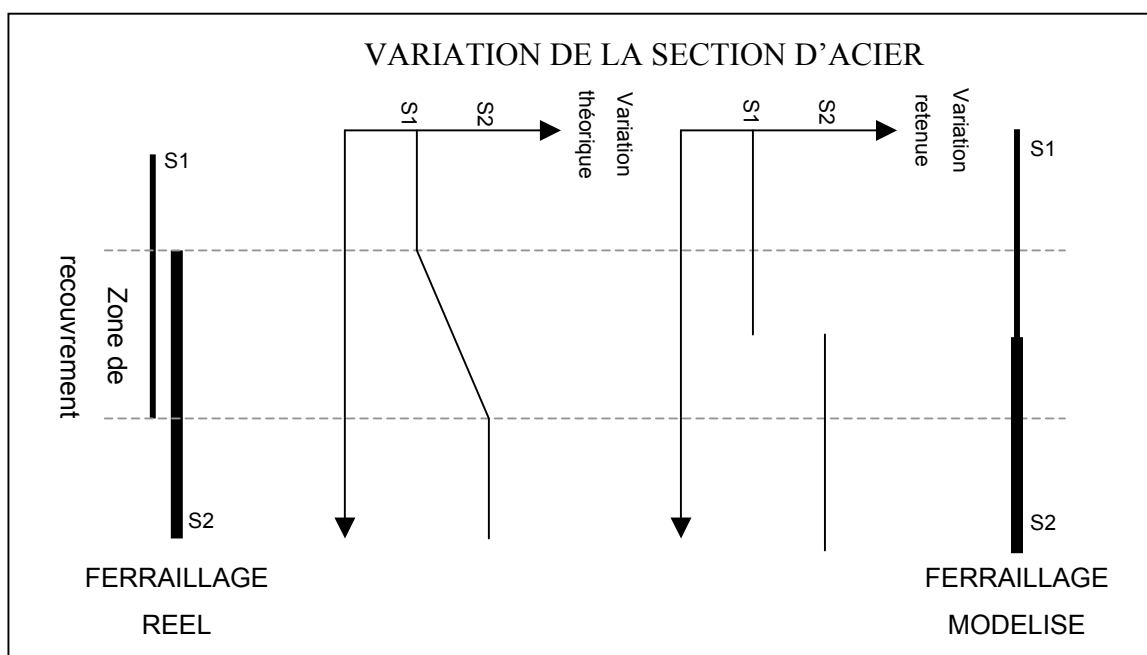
Section d'armature dans les zones de recouvrement d'armatures
